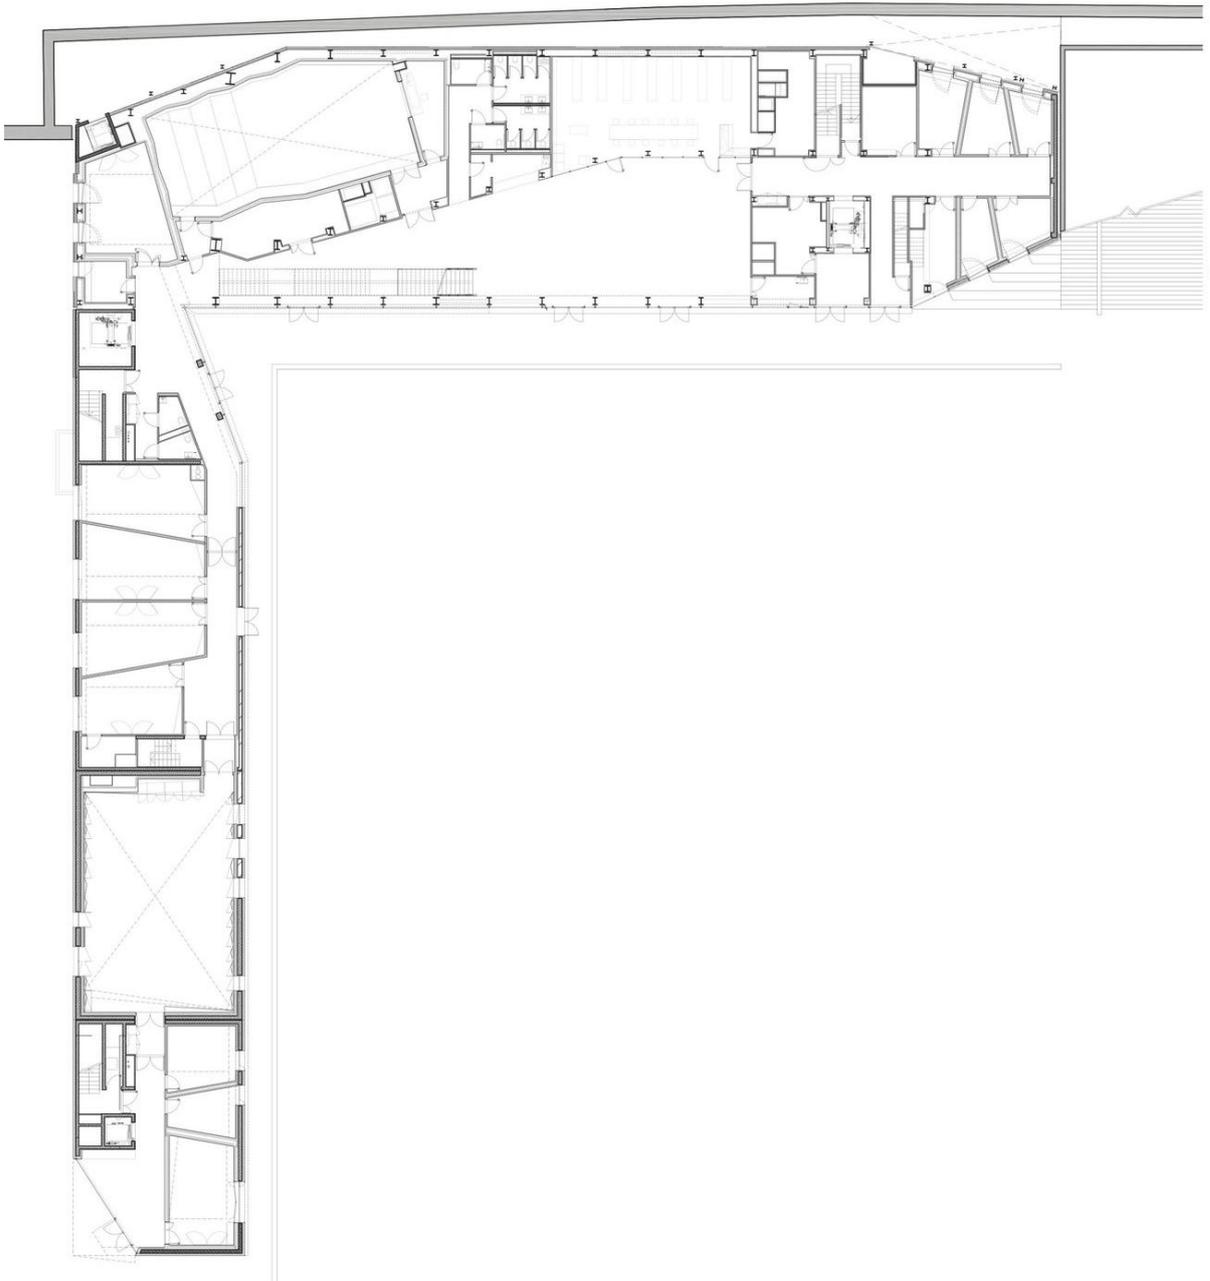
Planta do pavimento térreo (FONTE: Archidaily, 2014).
